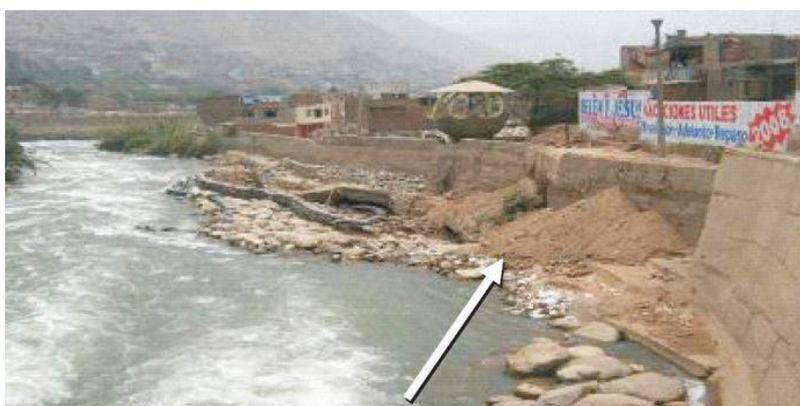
Muro de concreto ciclópeo del A.H. Cantagallo – distrito de chosica
